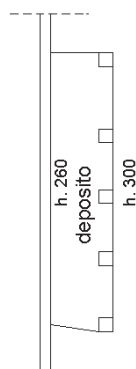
planimetria catastale del deposito al piano terra – sub 5
